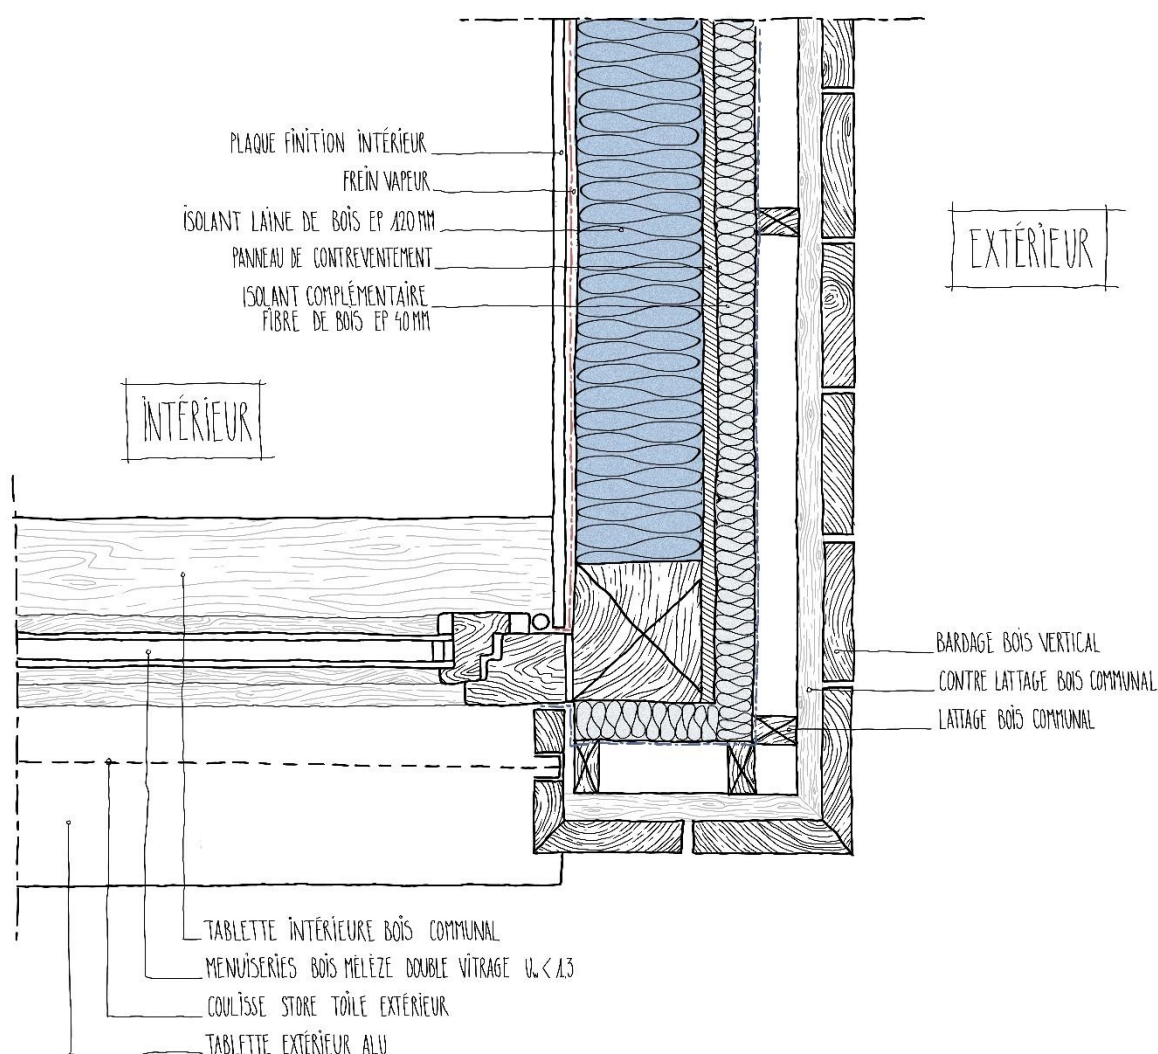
Croquis de la lucarne – vue en plan (source Mayker Architectes)
